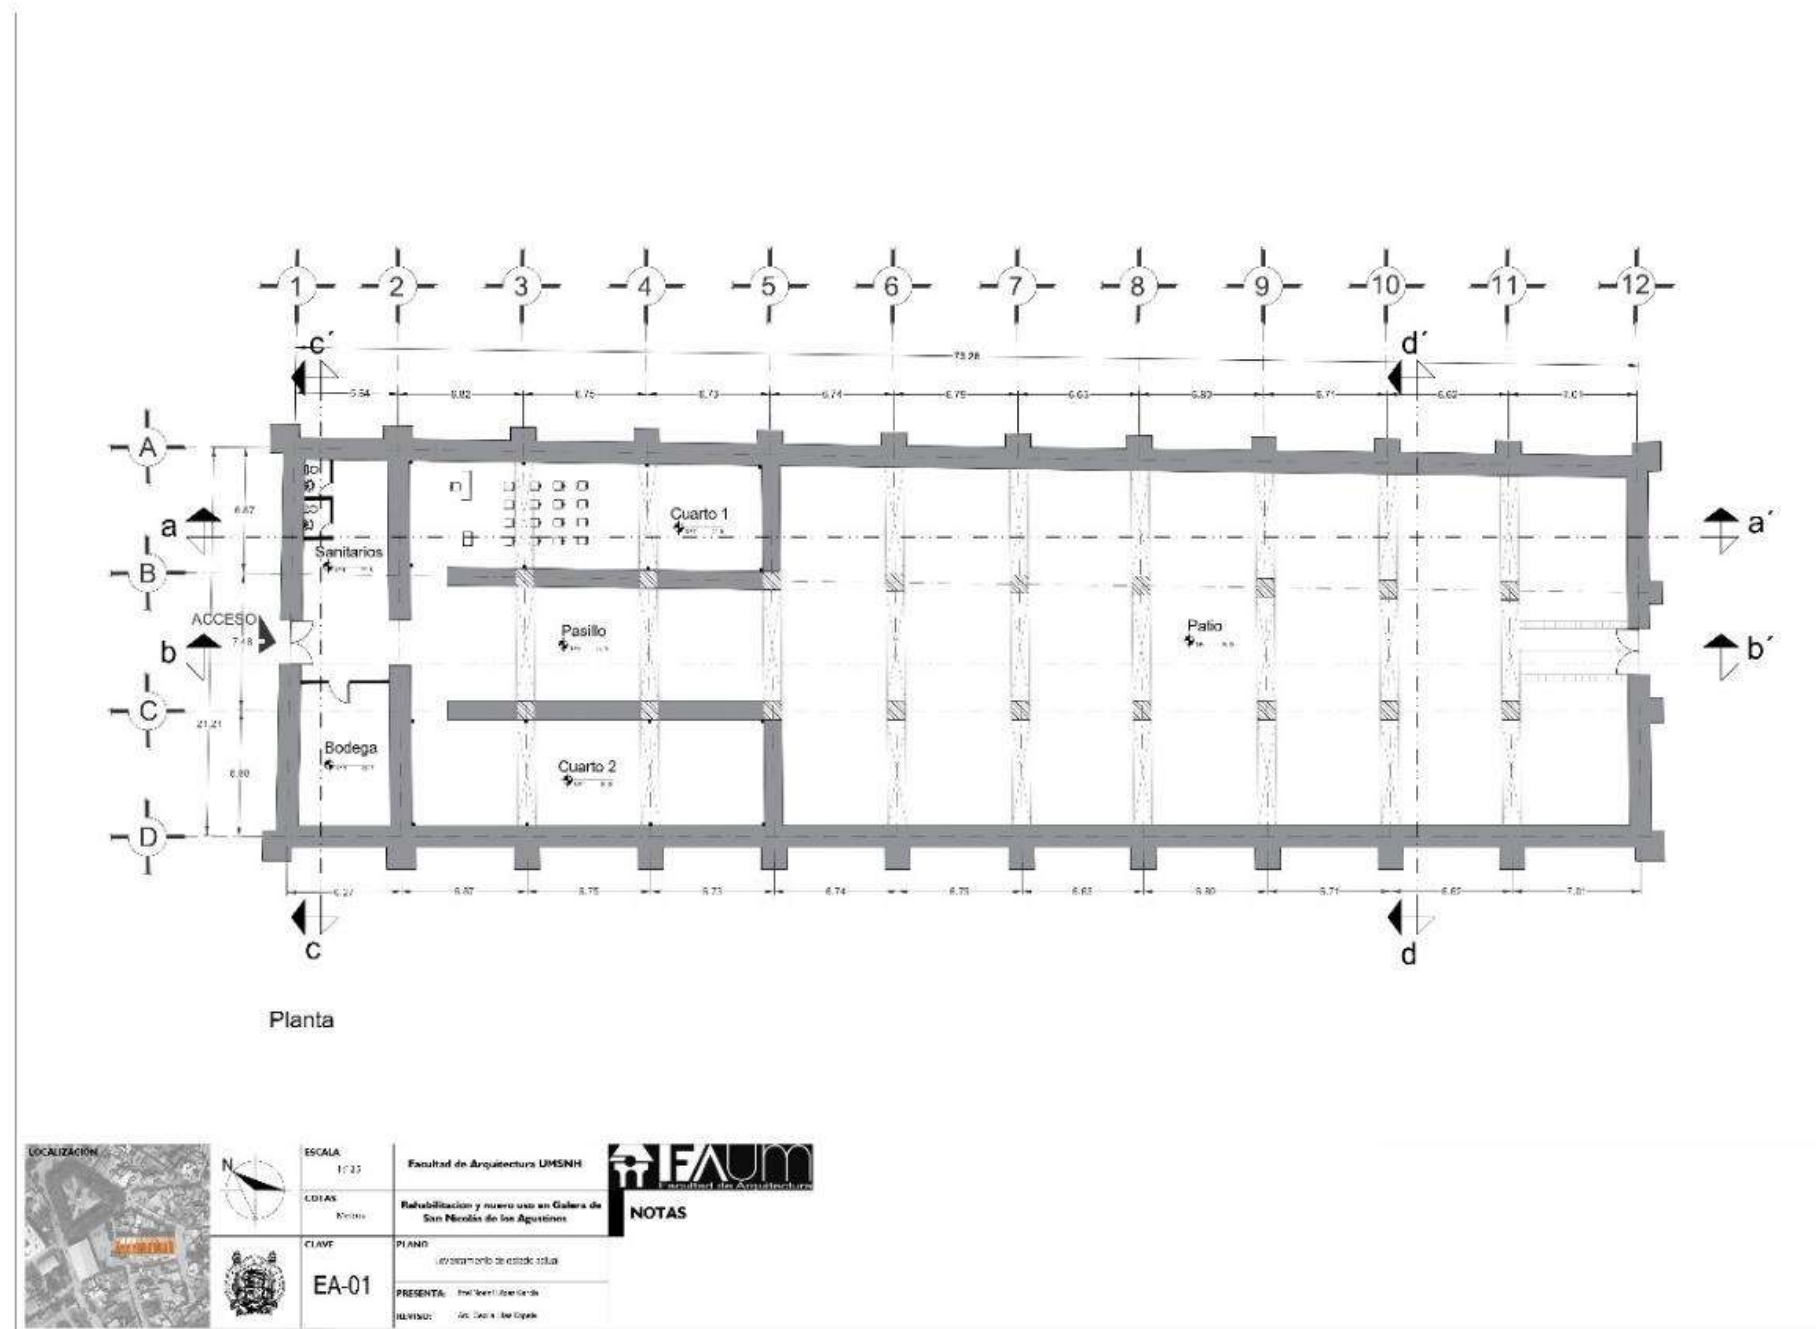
Plano estado actual 1. Fuente: Elaboración propia.
